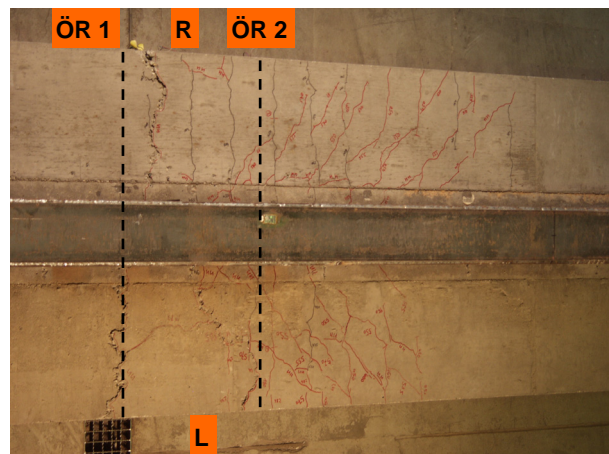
Rissbild auf der Betongurtunterseite
